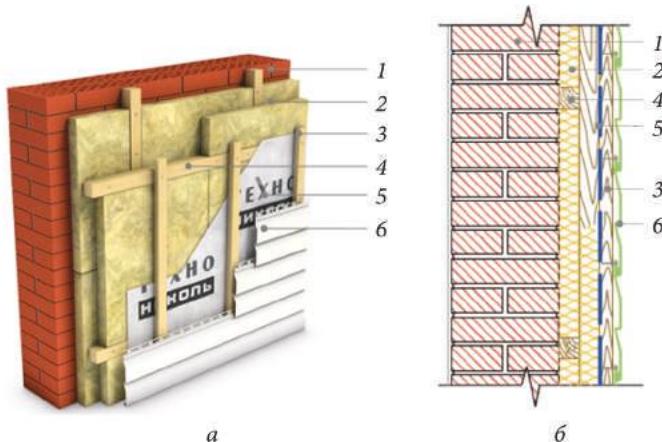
Система утепления с облицовкой виниловым сайдингом ТН-ФАСАД Сайдинг: а — общий вид; б — схема; 1 — несущая стена; 2 — утеплитель: минераловатные плиты ТЕХНОБЛОК; 3 — контррейка с шагом 400 мм, толщиной 30—50 мм; 4 — каркас под теплоизоляцию с шагом 600 мм, брус размером 50×50 мм; 5 — мембрана диффузионная *Tuyek* или мембрана супердиффузионная *ТехноНИКОЛЬ*; 6 — виниловый сайдинг
